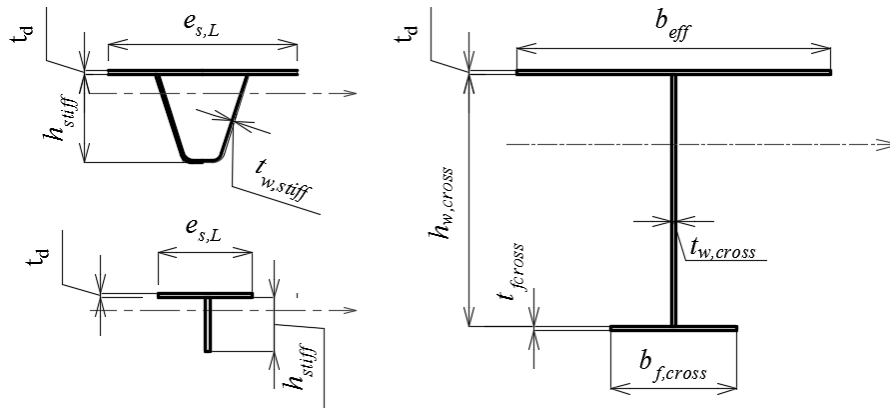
Перерізи поздовжніх ребер і поперечних балок. Позначки
